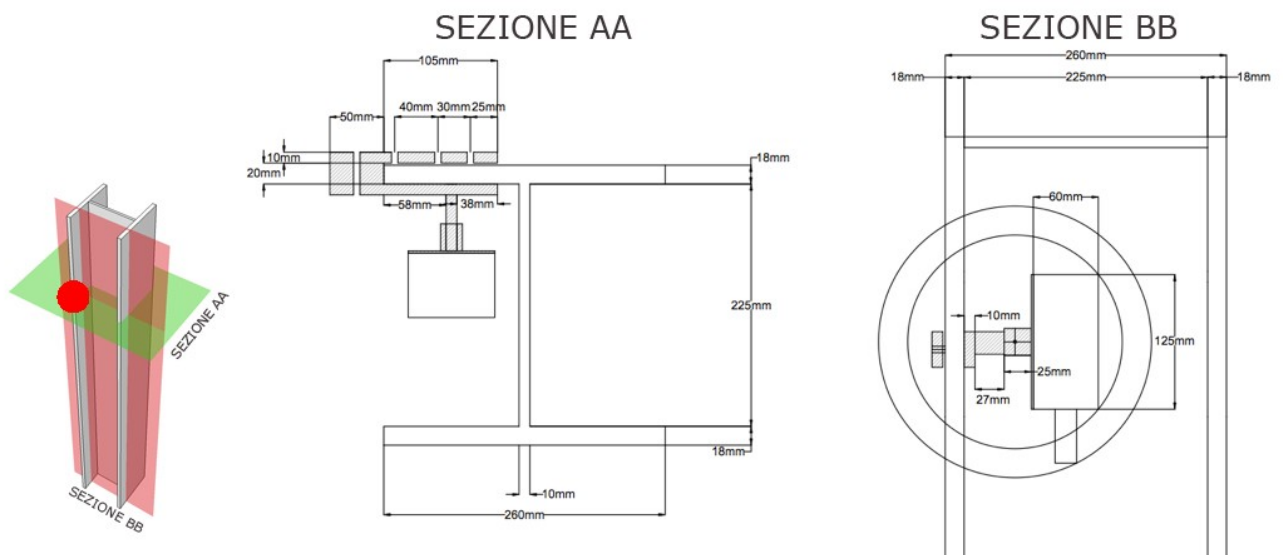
Progetto del sistema di collegamento del modulo BPM. a) Sezione trasversale AA b) Sezione longitudinale BB.
